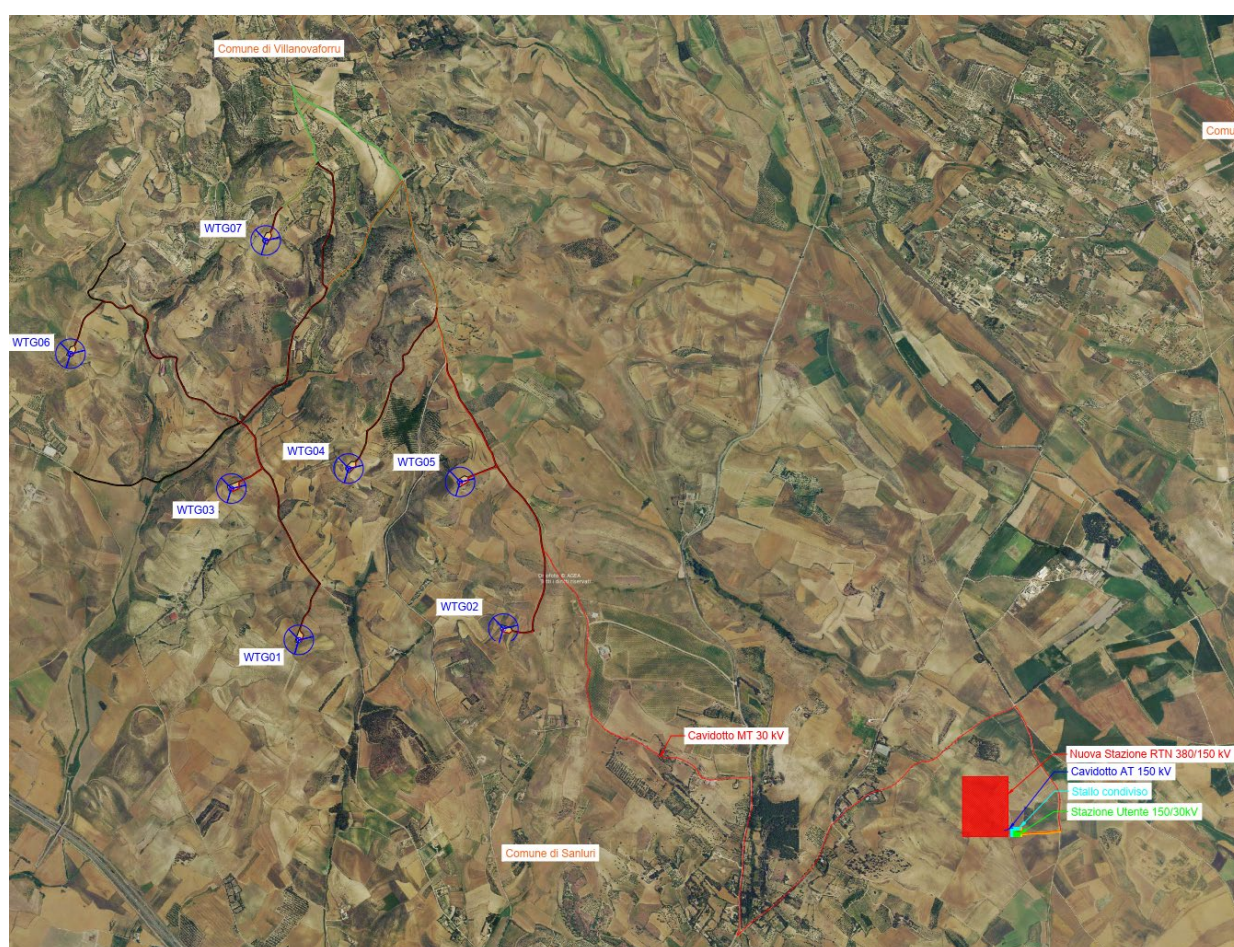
Layout della rete MT su ortofoto – impianto eolico
